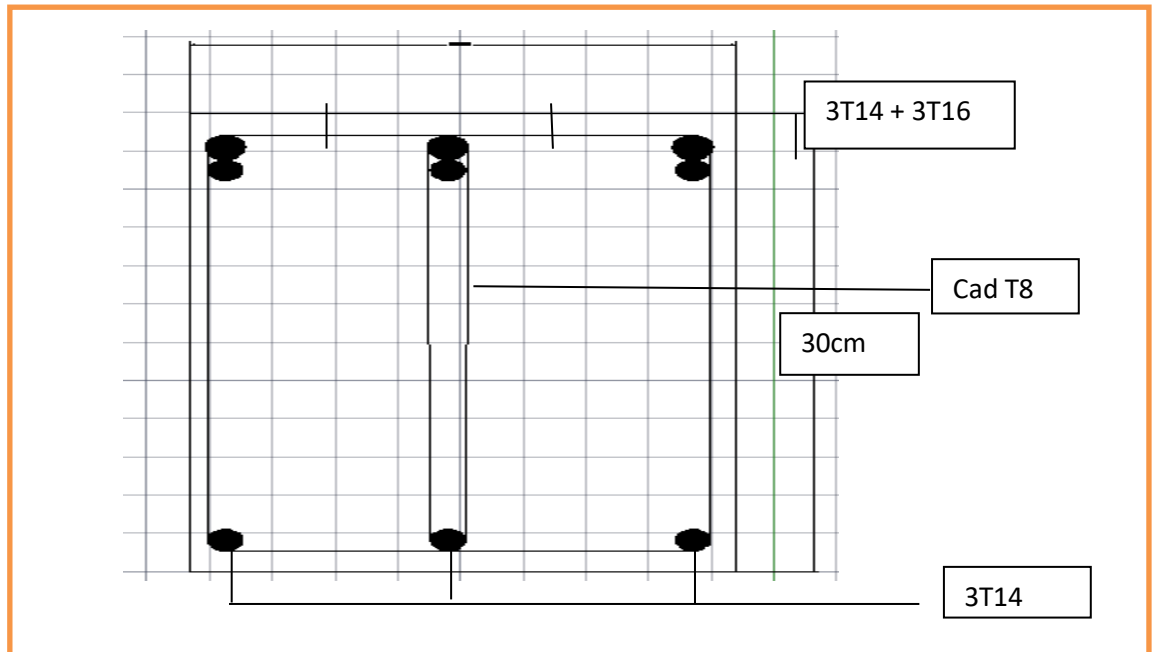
schéma de ferrailage de la poutre palière (RDC).
